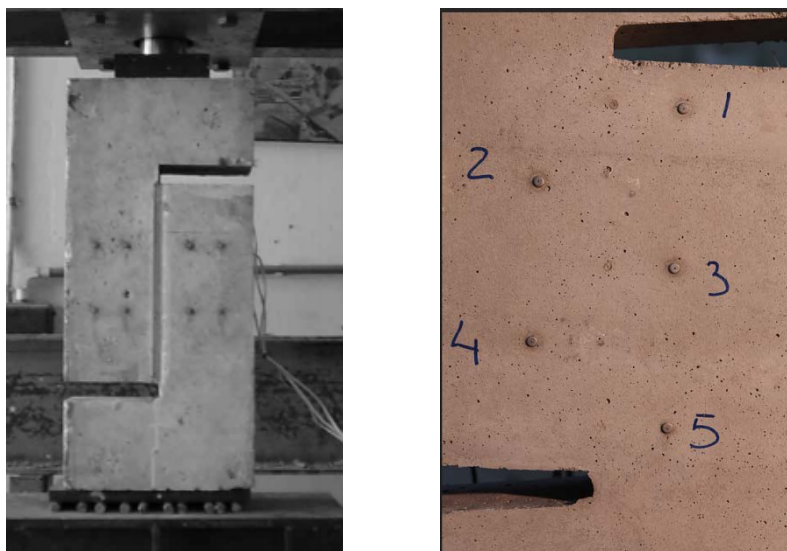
Push-off: (izquierda) con fisuración previa, (derecha) sin fisuración previa en el plano de corte.
